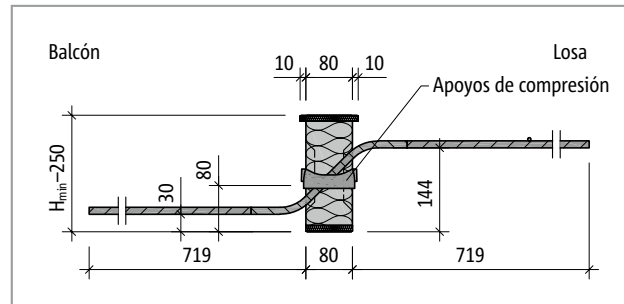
Schöck Isokorb® T tipo Q-V9 hasta Q-V11: Sección del producto
